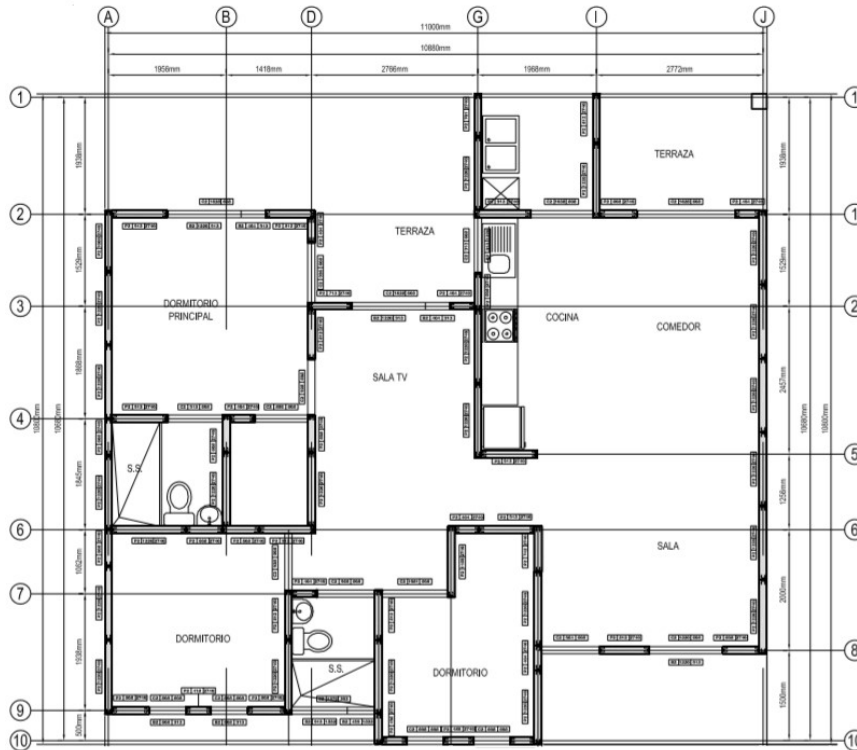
Ejemplo de planta arquitectónica de modulación de proveedor con panel SIP - Panacor.
